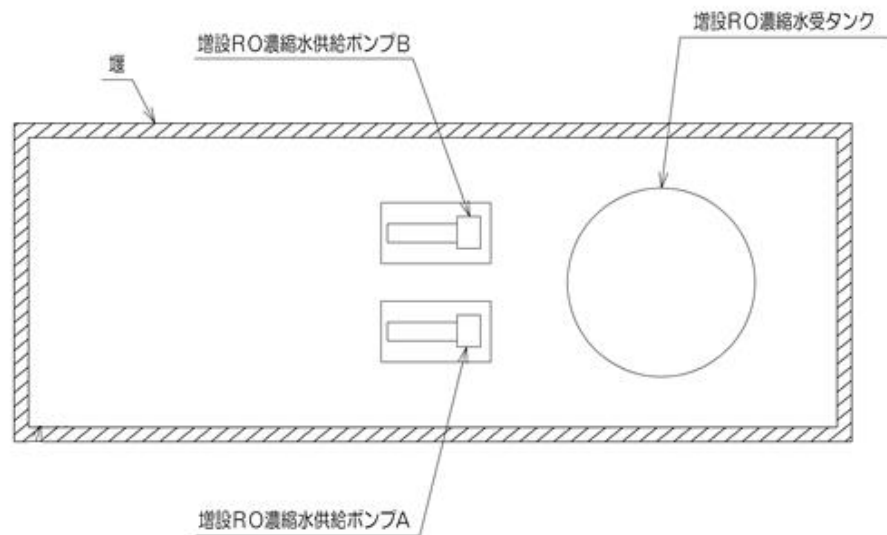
増設 RO 濃縮水受タンクの漏えい拡大防止 堰配置図
